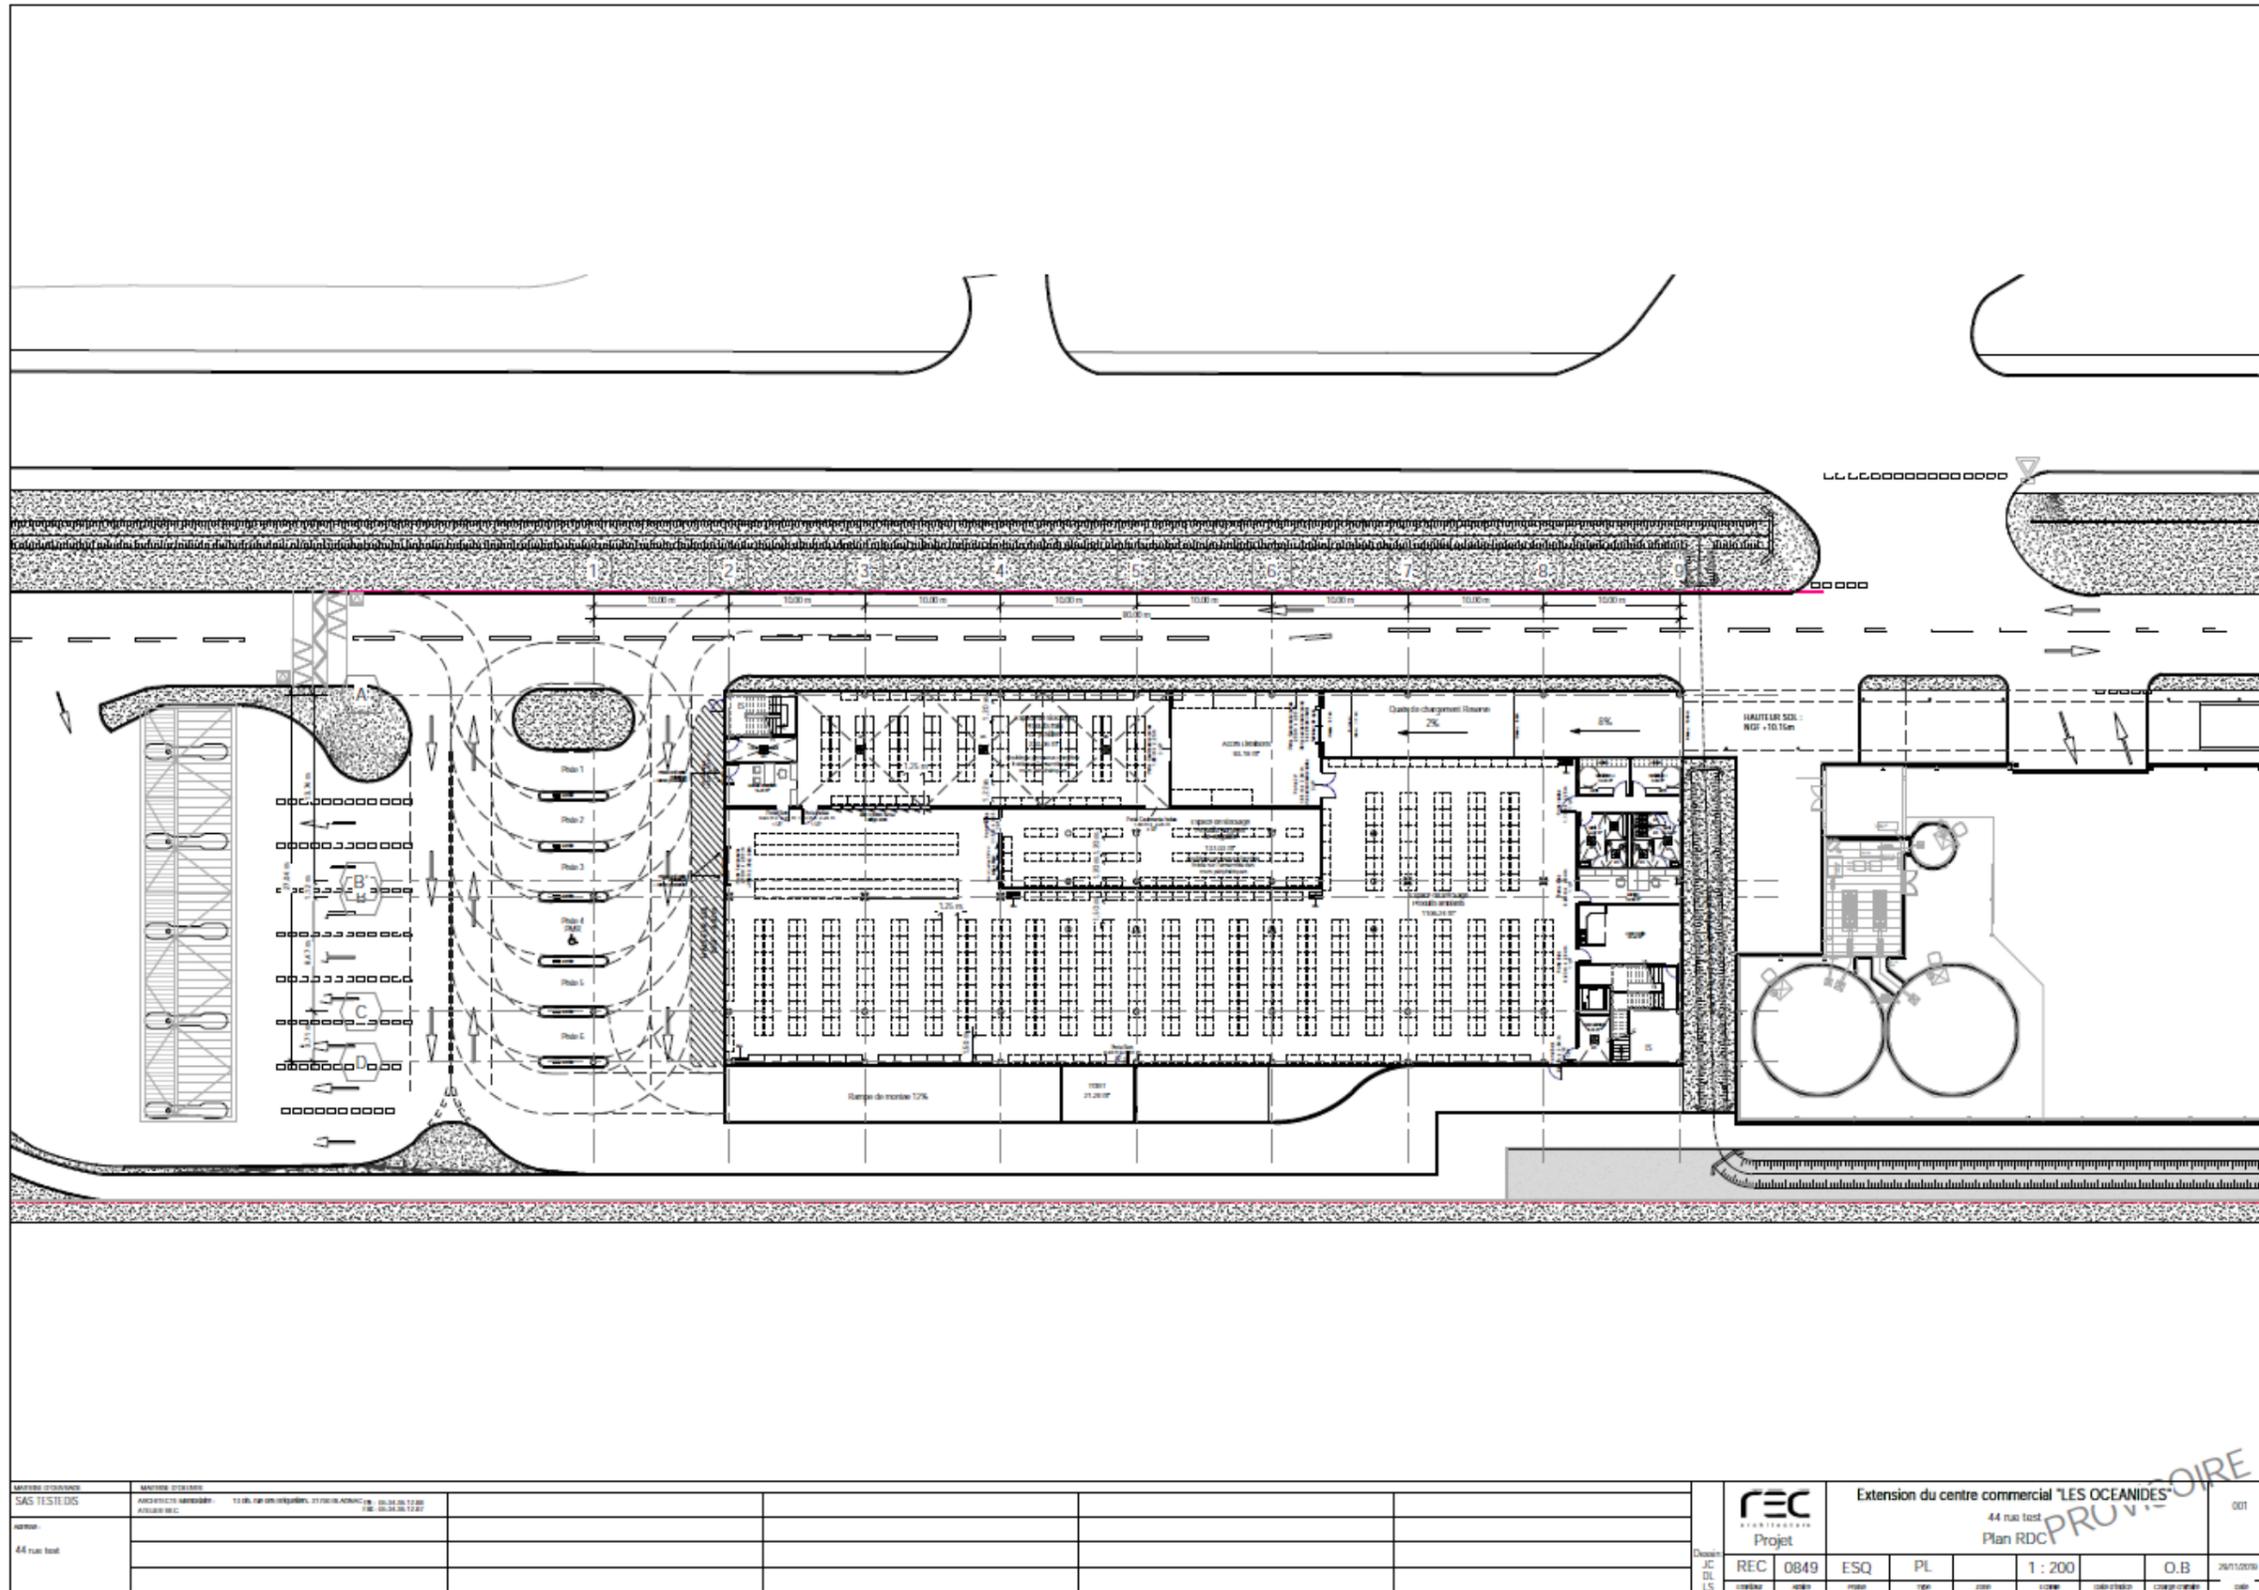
Plan de masse du projet –RDC (Source : REC Architecture)
